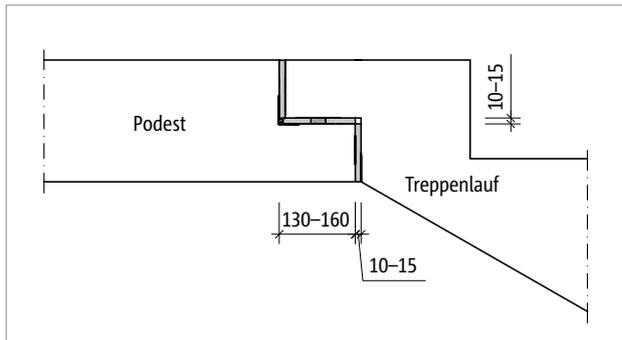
Schöck Tronsole® Typ F: Ausführungsvariante bündiger Treppenanschluss
